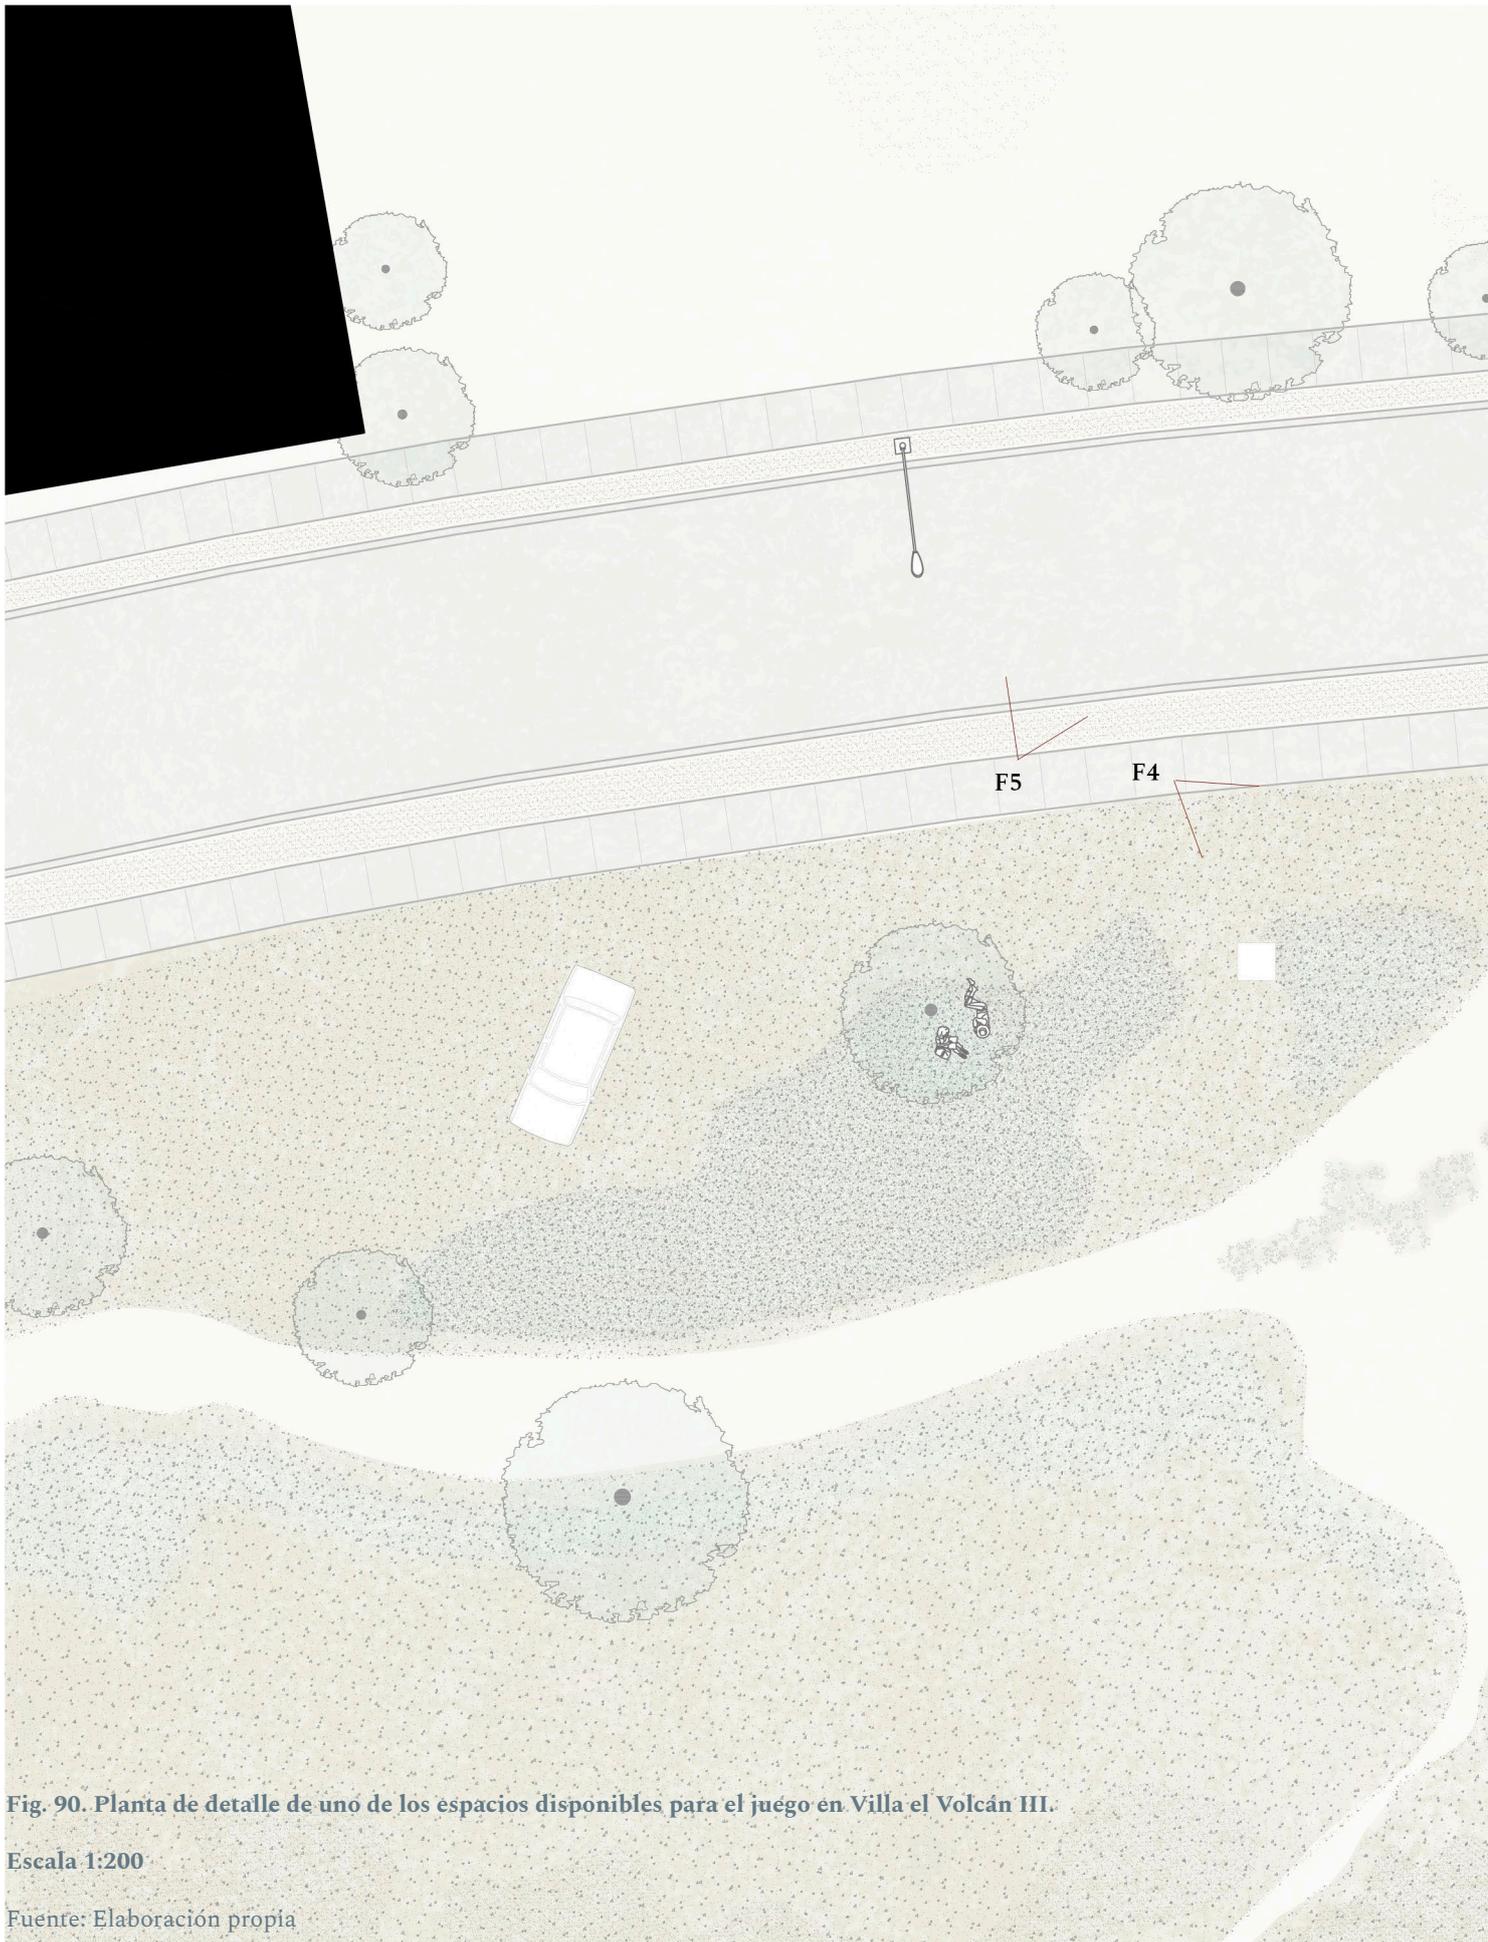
Planta de detalle de uno de los espacios disponibles para el juego en Villa el Volcán III.
